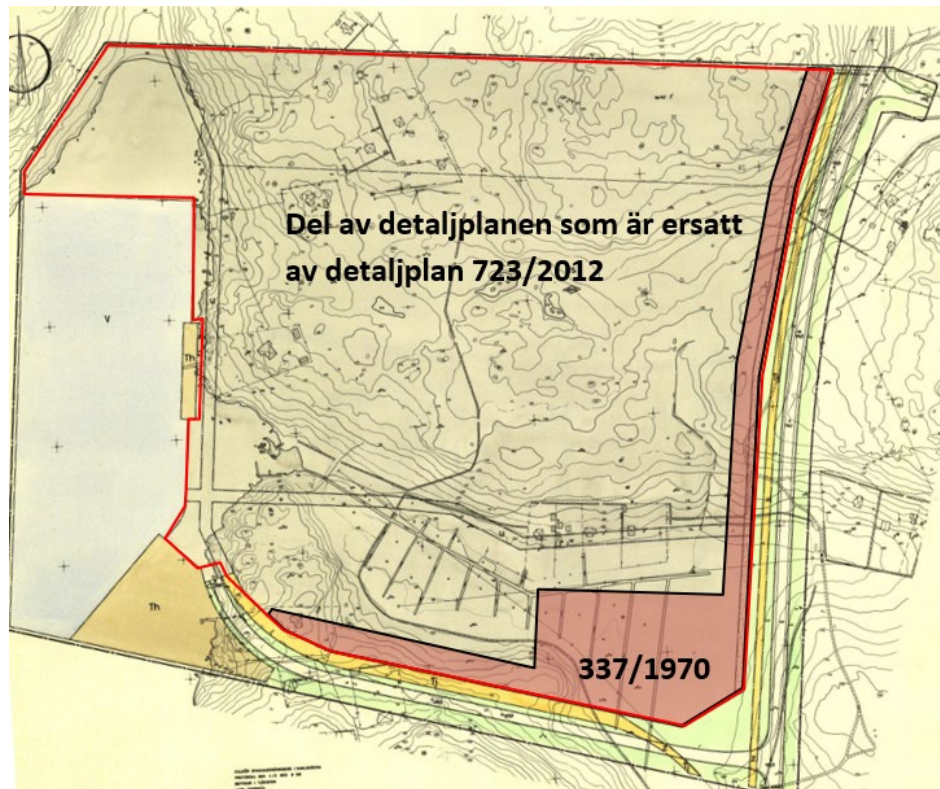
Detaljplan 337 från 1970. Röd linje markerar ungefärligt planområde. Yta markerad med röd ifylld färg markerar den del av detaljplan 337 som avsevärs ersätts med ny. All övrig mark inom planområdet har tidigare ersatts av detaljplan 723/2012.
